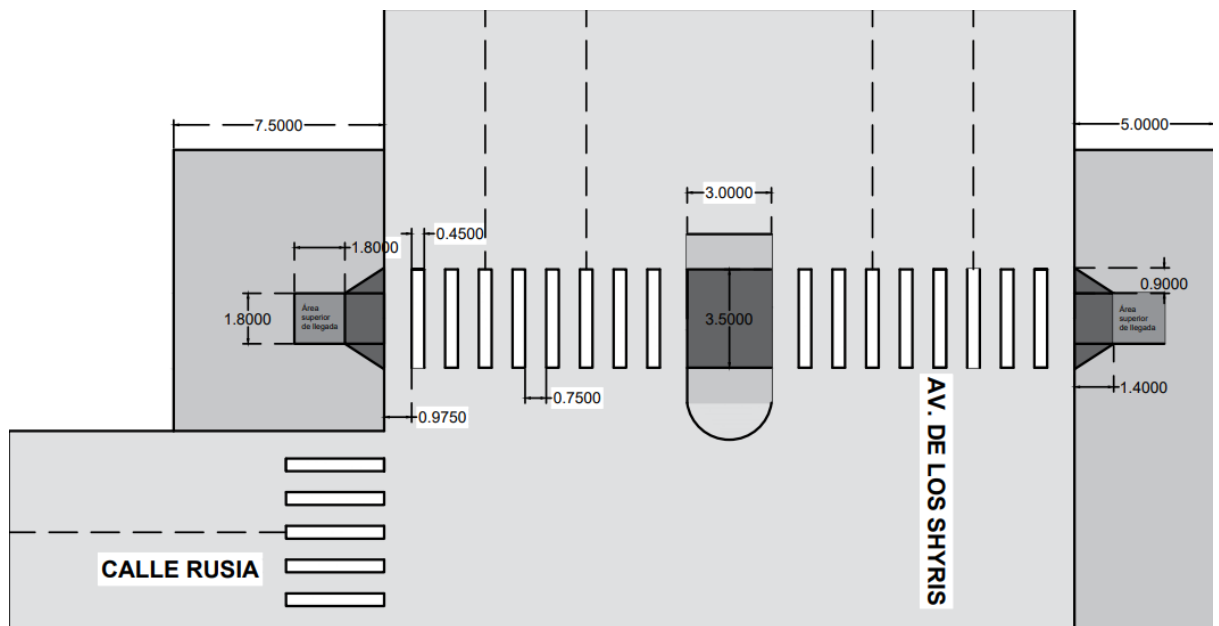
Vista en planta del dimensionamiento de la facilidad peatonal
